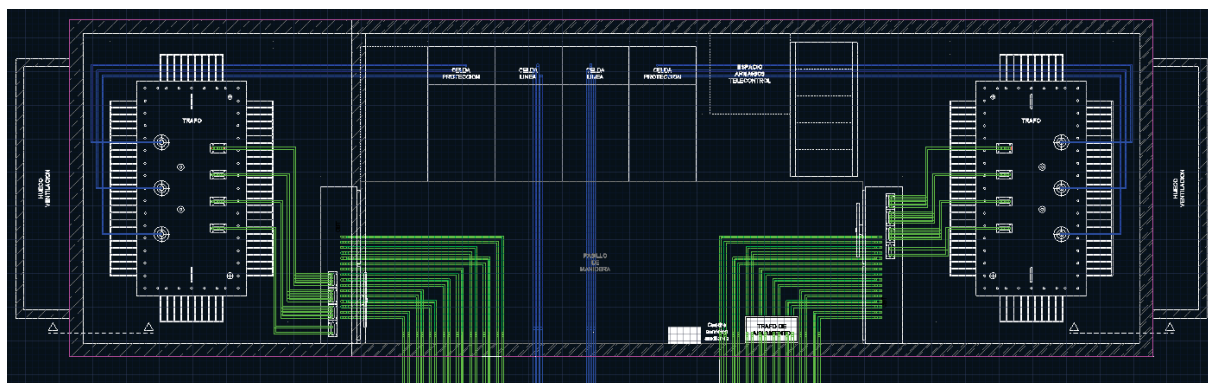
Vista en planta de la instalación (2L+2T [Sub]) (cotas en mm).
